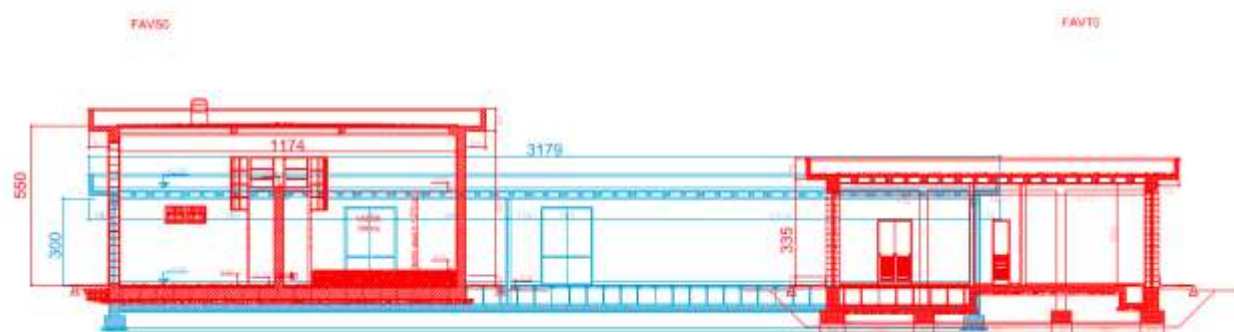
Sezione longitudinale del fabbricato FA93 nel Progetto approvato
